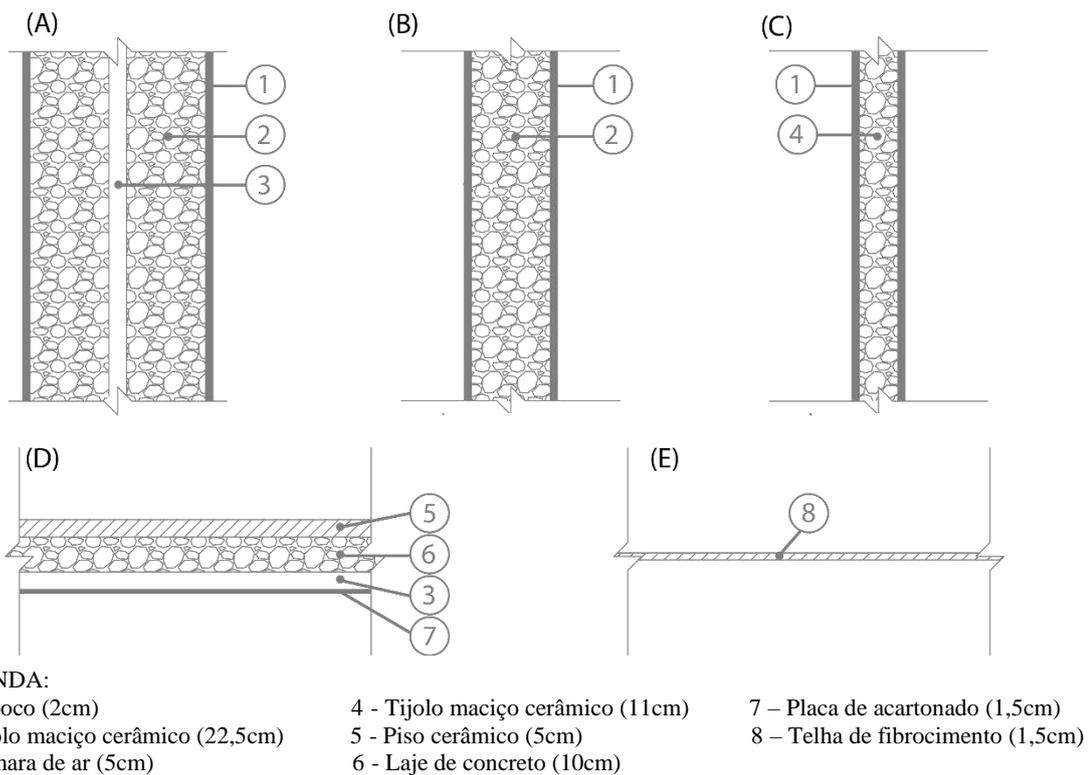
Estrutura dos elementos construtivos: (A) Parede externa 1ºPV; (B) Parede externa 2ºPV; (C) Parede Interna; (D) Piso interno; (E) Cobertura (Autores, 2018)
